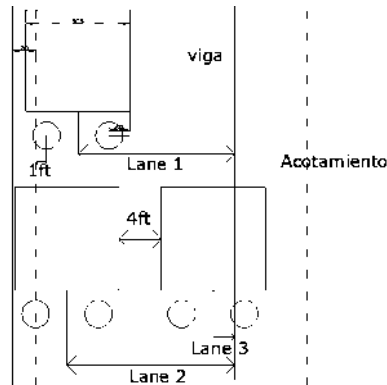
“Lanes”, con la herramienta “Bridge Loads” (SAP2000).
